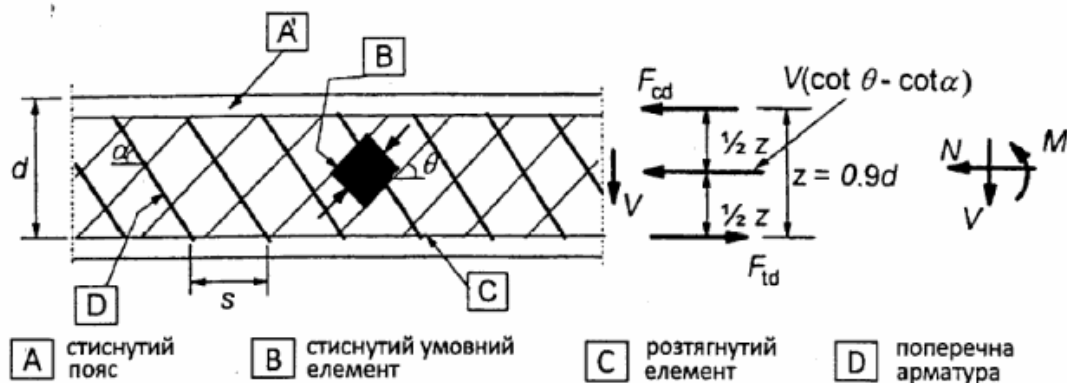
Ферменна модель і позначення для елементів з поперечною арматурою.
